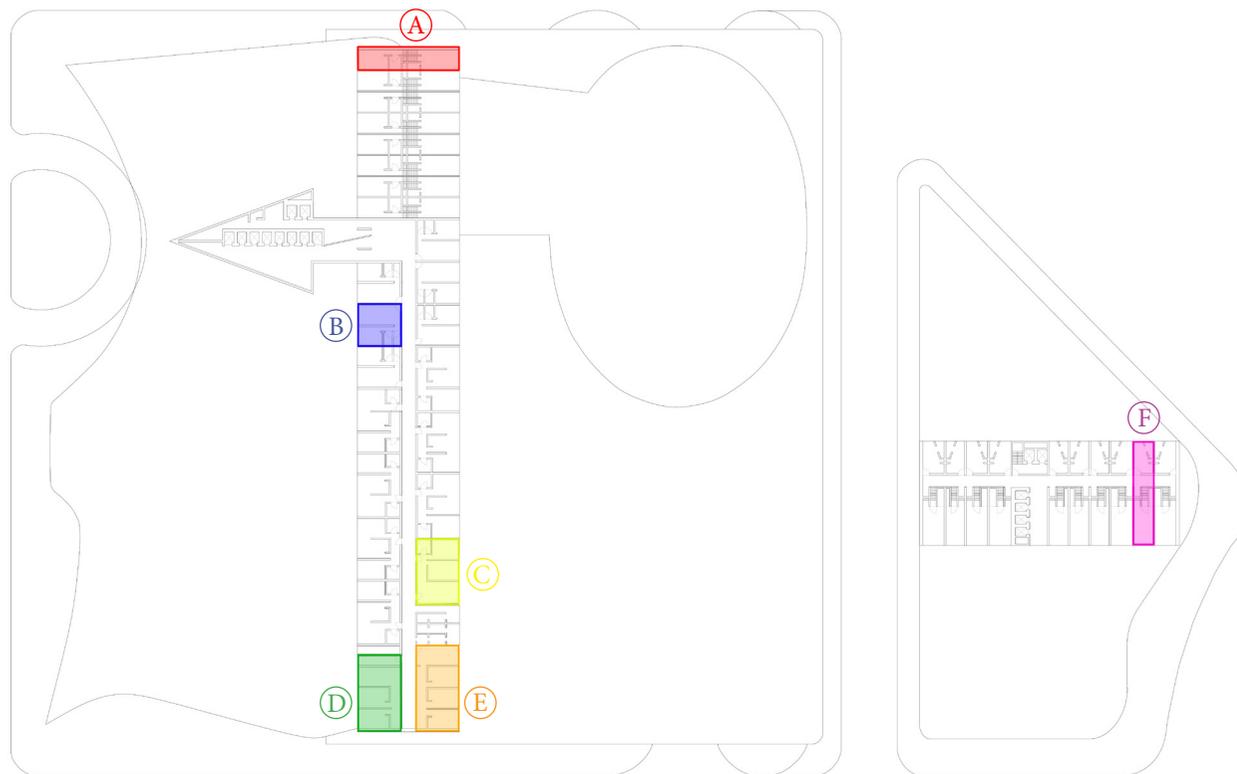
Esquema de la planta tipo indicando las distintas tipologías de vivienda.
